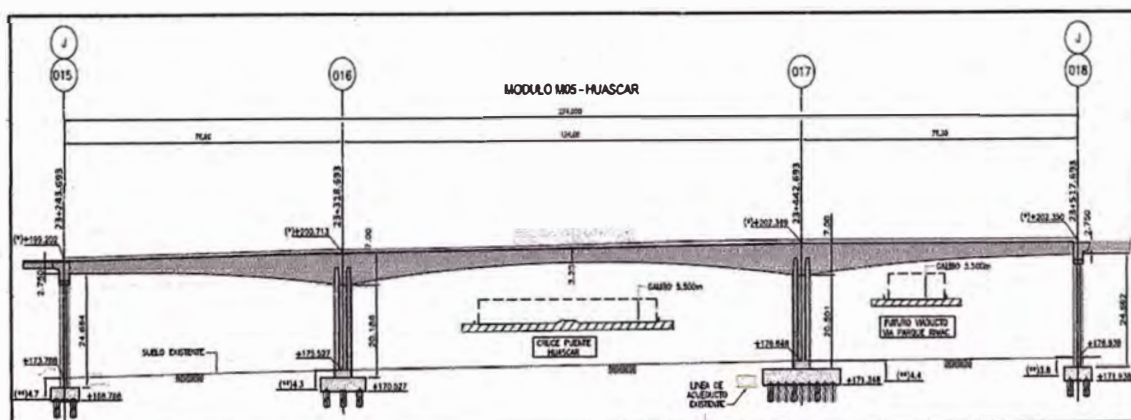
Vista de elevación del Puente sobre la Vía de Evitamiento
